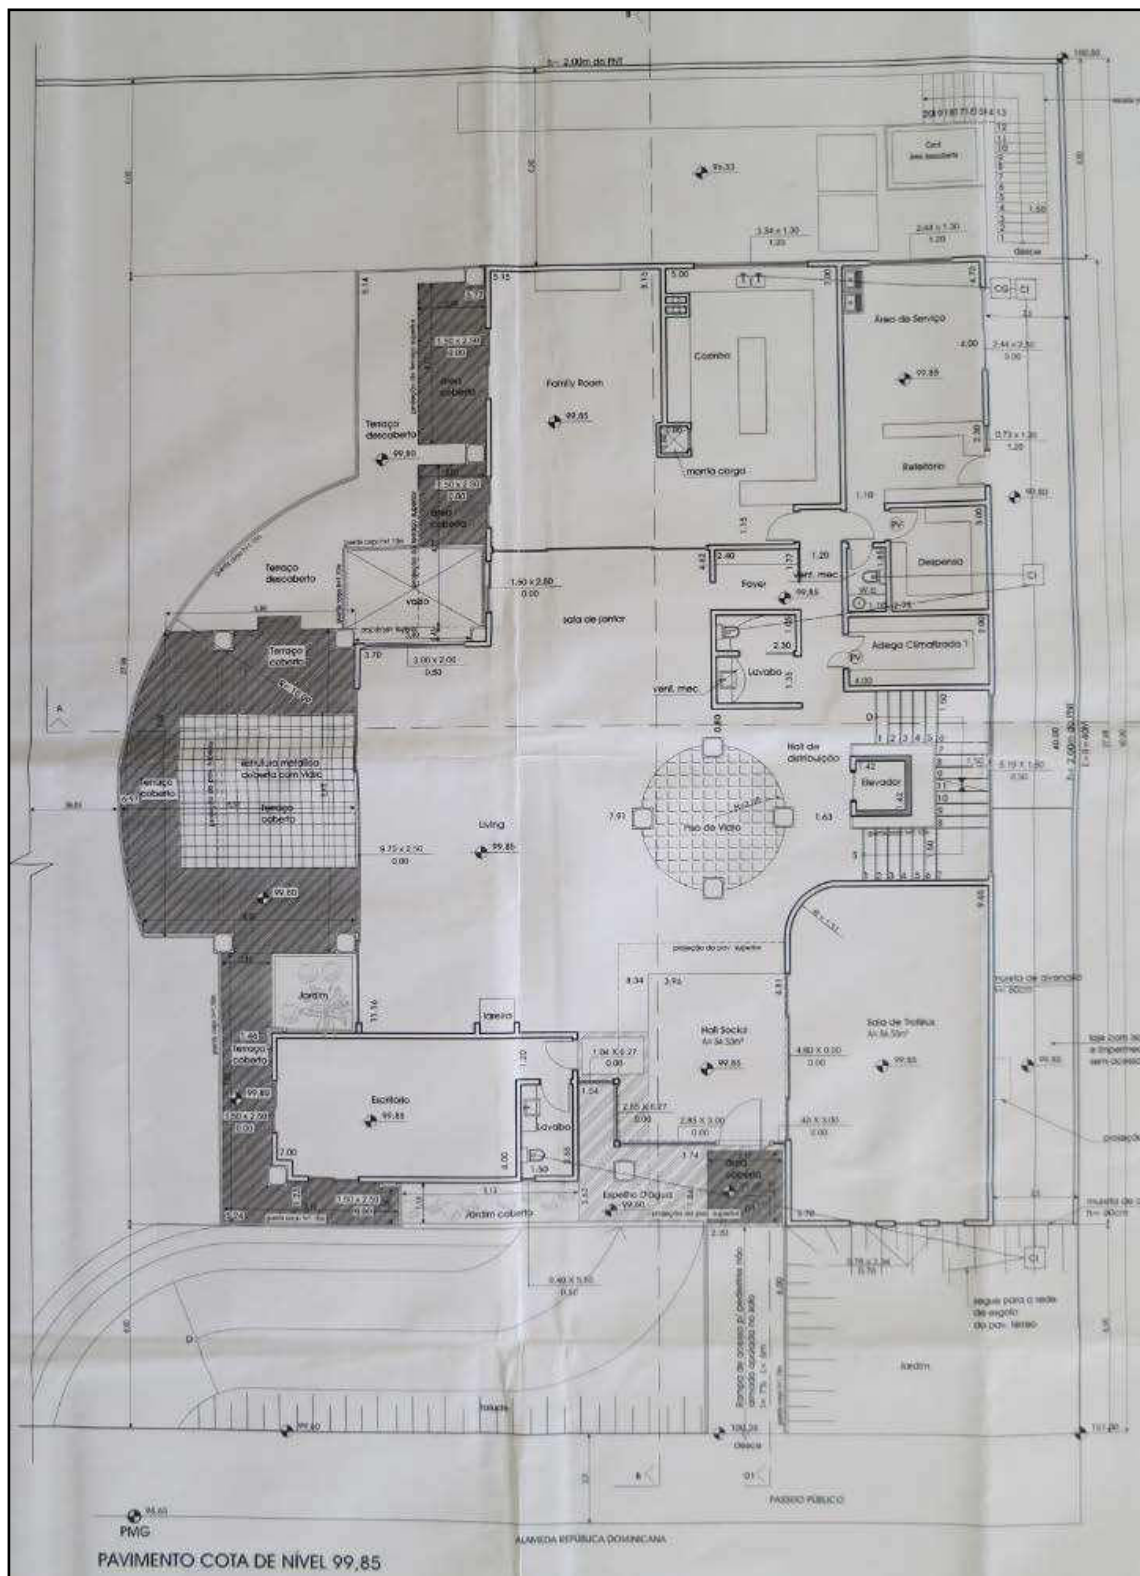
Cópia da planta do pavimento da cota 99,85 (área social).
